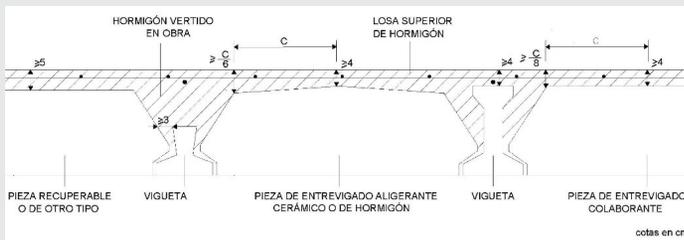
EHE-08: Condiciones geométricas del forjado cerámico
